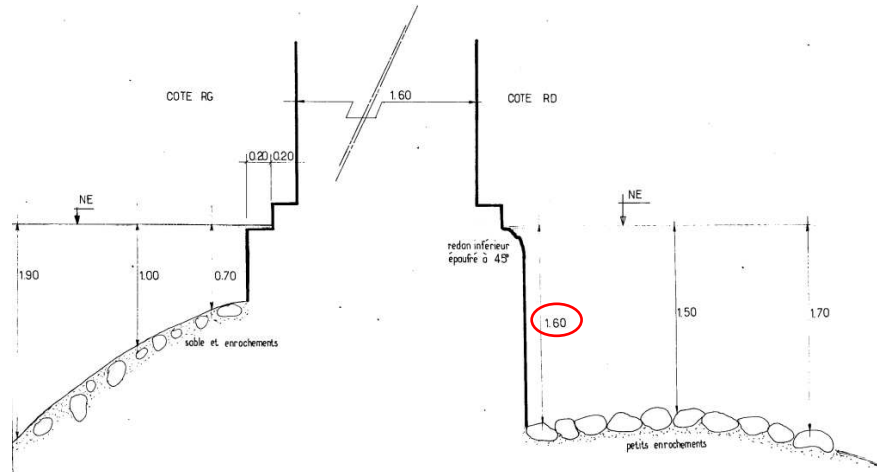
Coupe transversale de la pile 2 – Source : Document de visite avant travaux d'élargissement
